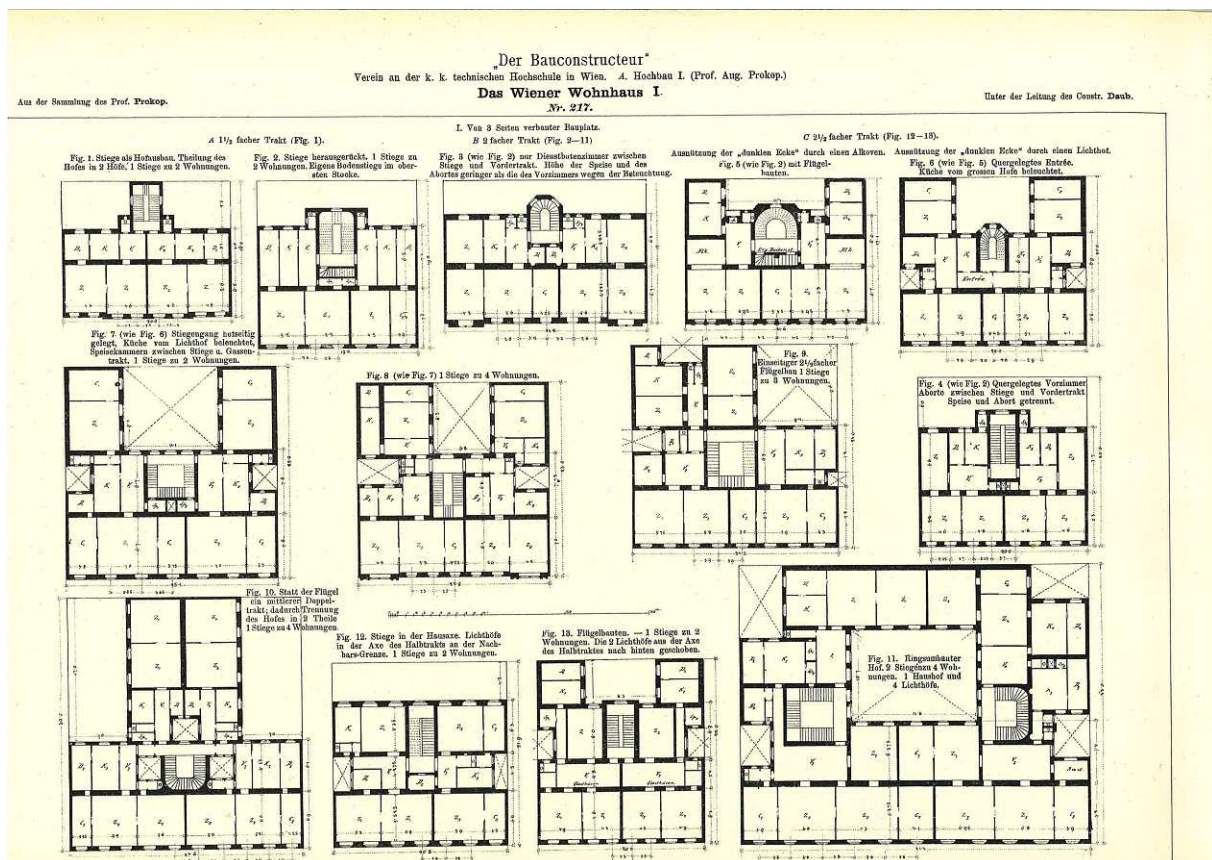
Grundrissformen von Wiener Wohnhäusern für rechteckige Grundstücke [22]
